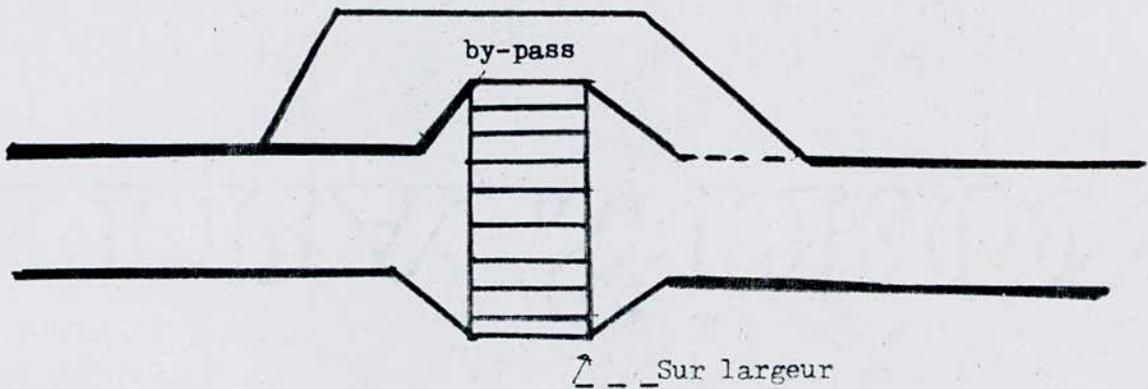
Shéma d'une installation de dégrillage manuelle.
